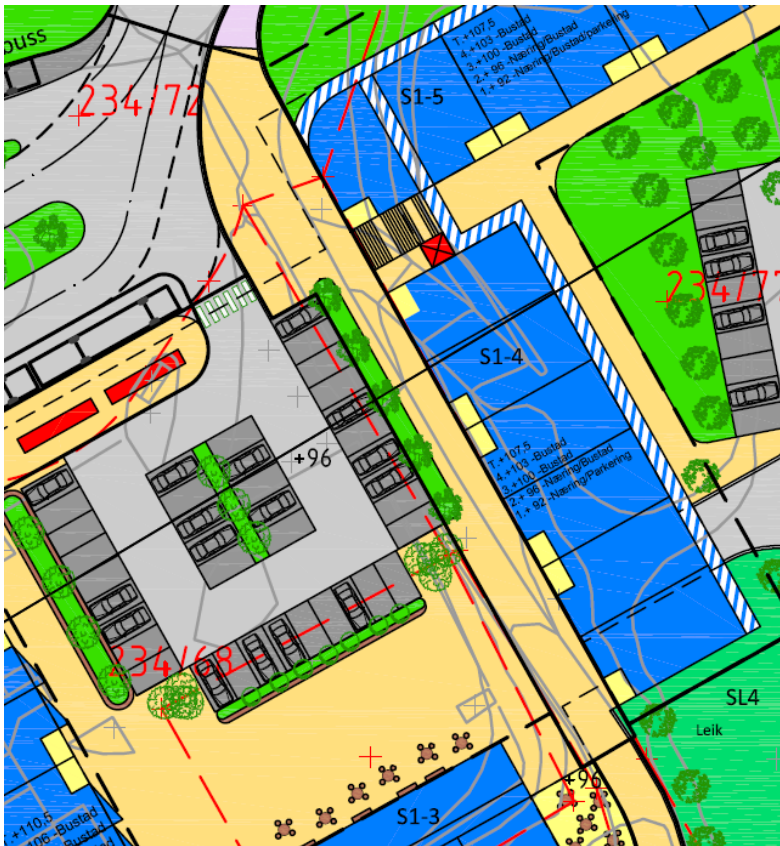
Illustrasjon av kollektivterminal (ABO Plan & Arkitektur AS)
